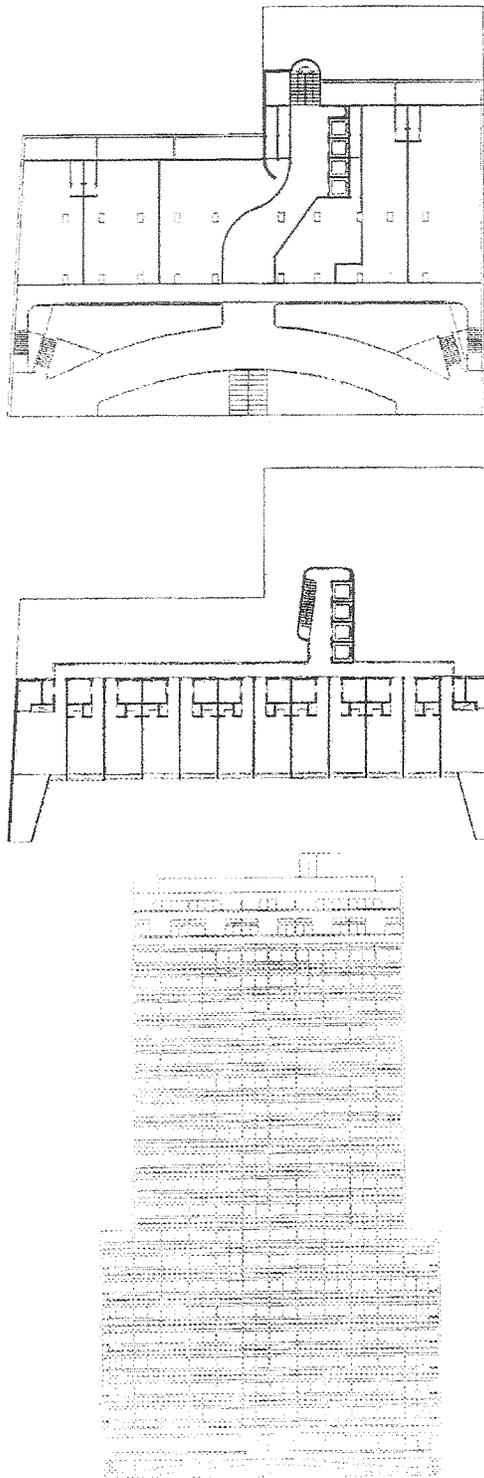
Edifício Normandie de Franz Heep, 1955, São Paulo. Planta do pavimento térreo, planta tipo e elevação
